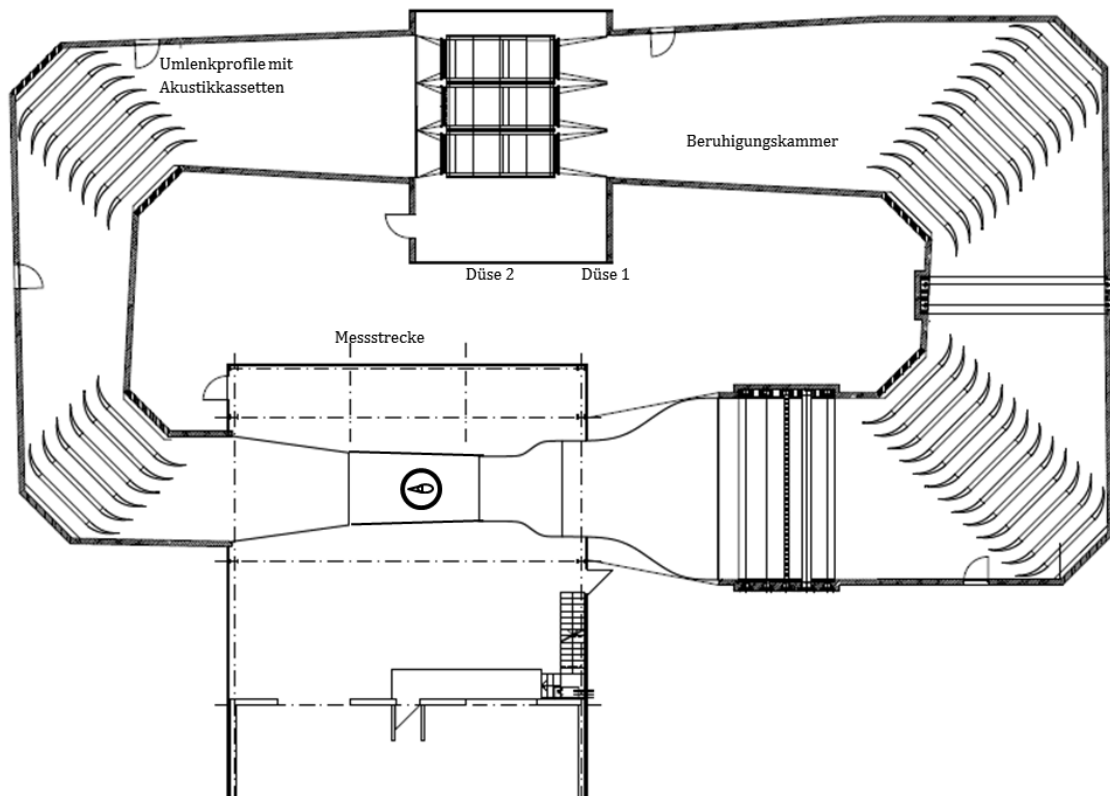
Grundriss Windkanal Deutsche WindGuard.
